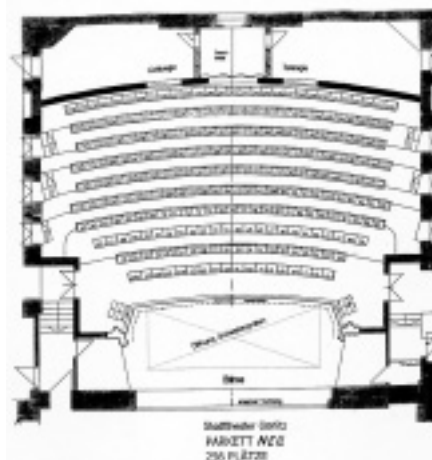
Grundriss Saal nach dem Umbau
